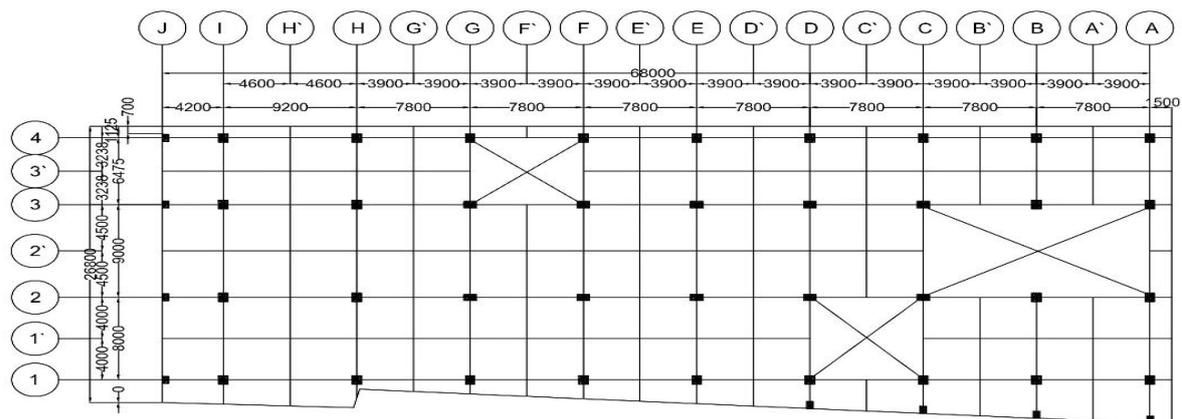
Denah Lantai Tanpa Balok Anak (Pola I)
